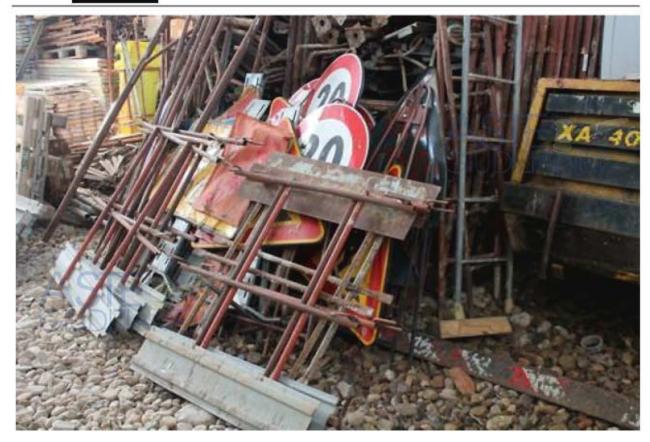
Fermapiede con corrimano e segnaletica stradale.
